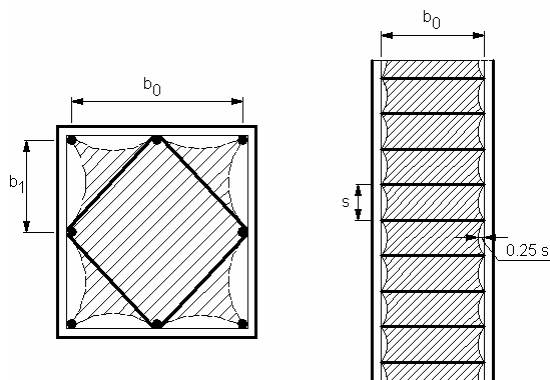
Zona de beton efectiv confinată a) în plan b) în elevație
